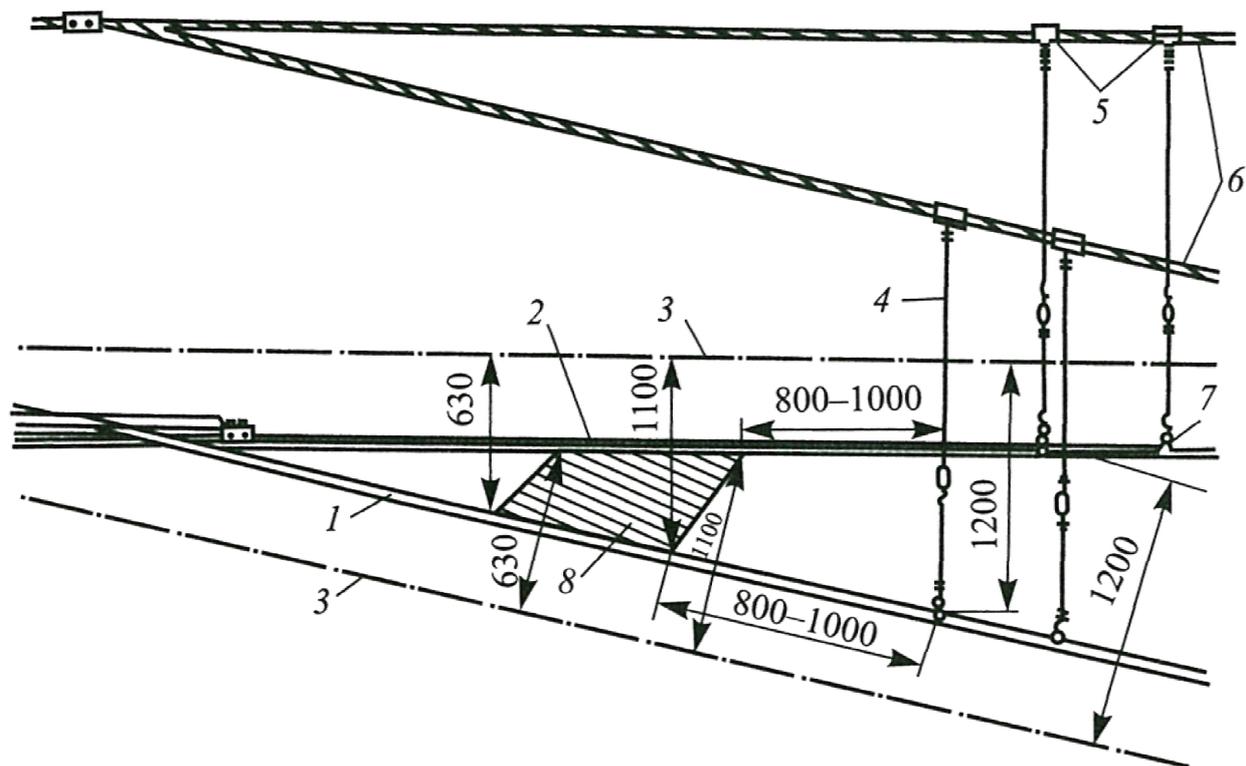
Зона подхвата и двойные вертикальные звеньевые струны на воздушной стрелке: 1 и 2 — контактные провода отклоненного и прямого путей; 3 и 9 — оси прямого и отклоненного путей; 4 — звеньевые струны (БМ-4); 5 — зажим для троса К-037 (К040); 6 — несущие тросы; 7 — зажим струновой К-046; 8 — зона подхвата
